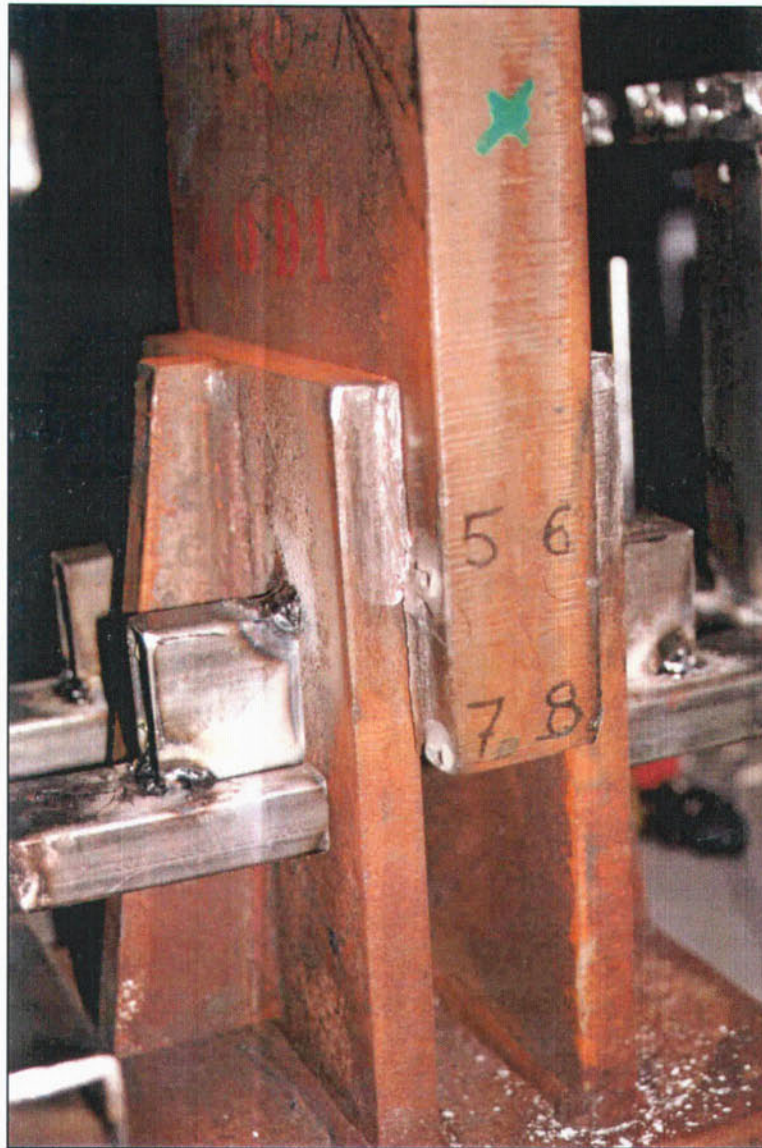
Detalle de la probeta 1S ya rota, con las soldaduras limpias de cal. Se observa en la fotografía la rotura de las soldaduras 5-7 y 6-8 por la sección de garganta.
